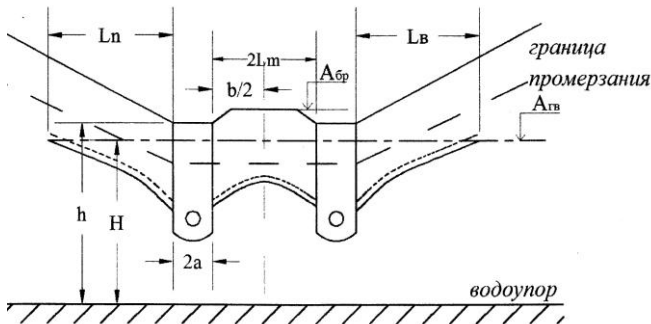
Расчетная схема к определению глубины заложения дренажа h
